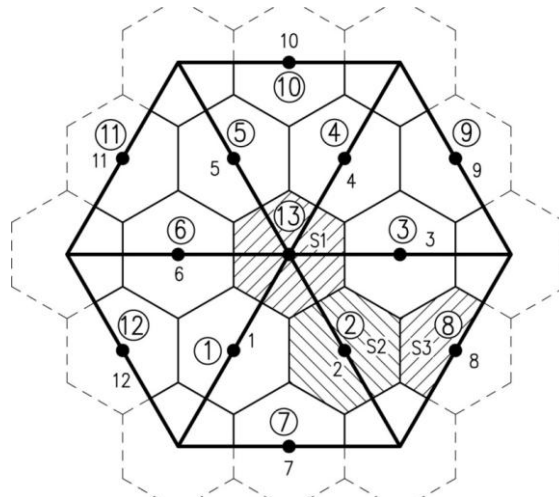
Схема расположения точек загрузки и формы грузовых площадей
